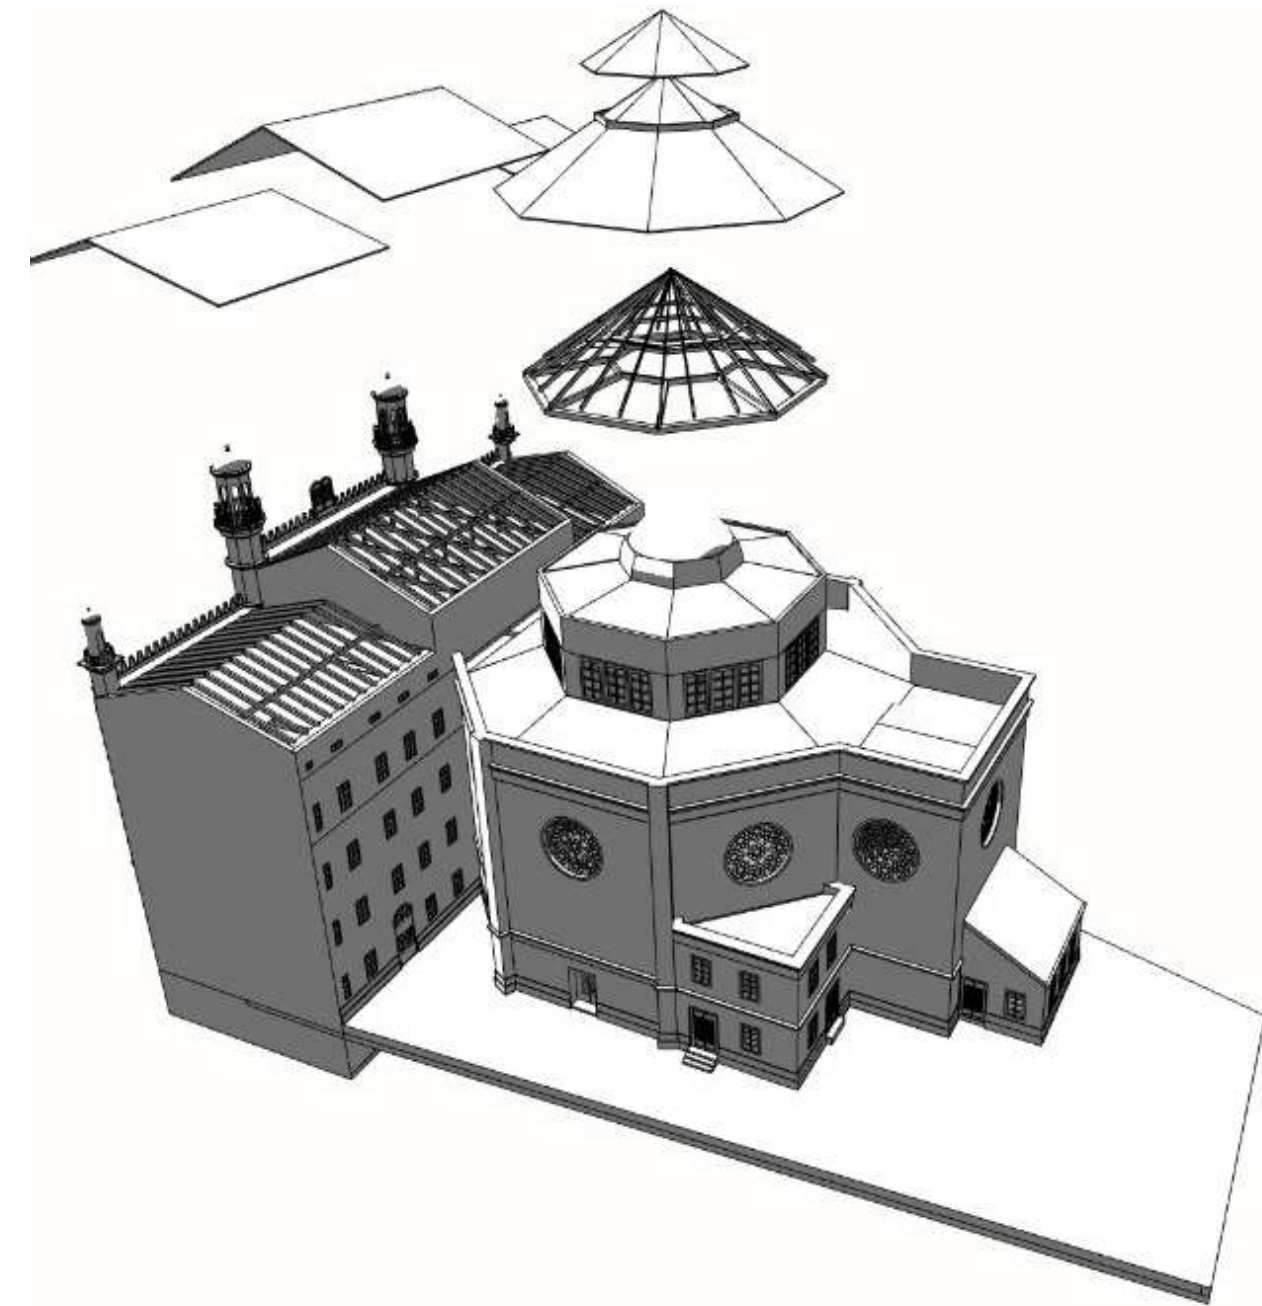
3D Rekonstruktion, Dachstuhl sichtbar, Modelldarstellung
